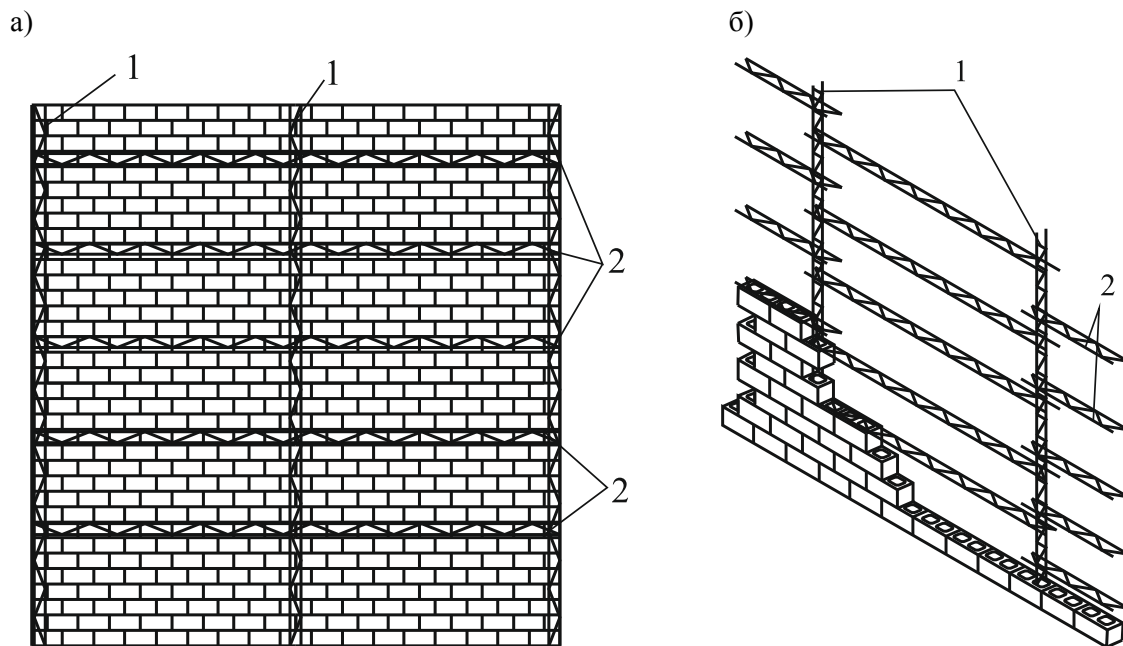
Армирование стен вертикальными 1 и горизонтальными 2 сетками фирмы Murfor [33]
